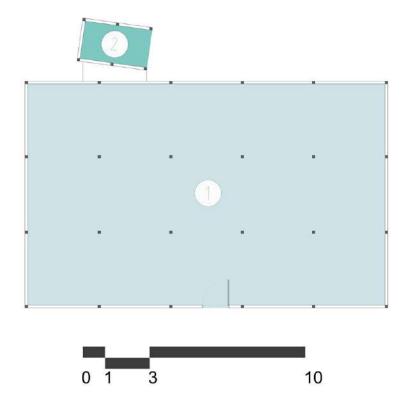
Planta 1 Bloque 32. Fuente: Equipo de diagnóstico.
